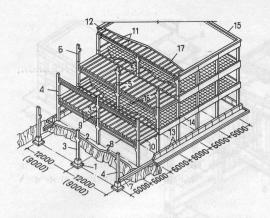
Железобетонный каркас многоэтажного промышленного здания с пролетами 12 м
